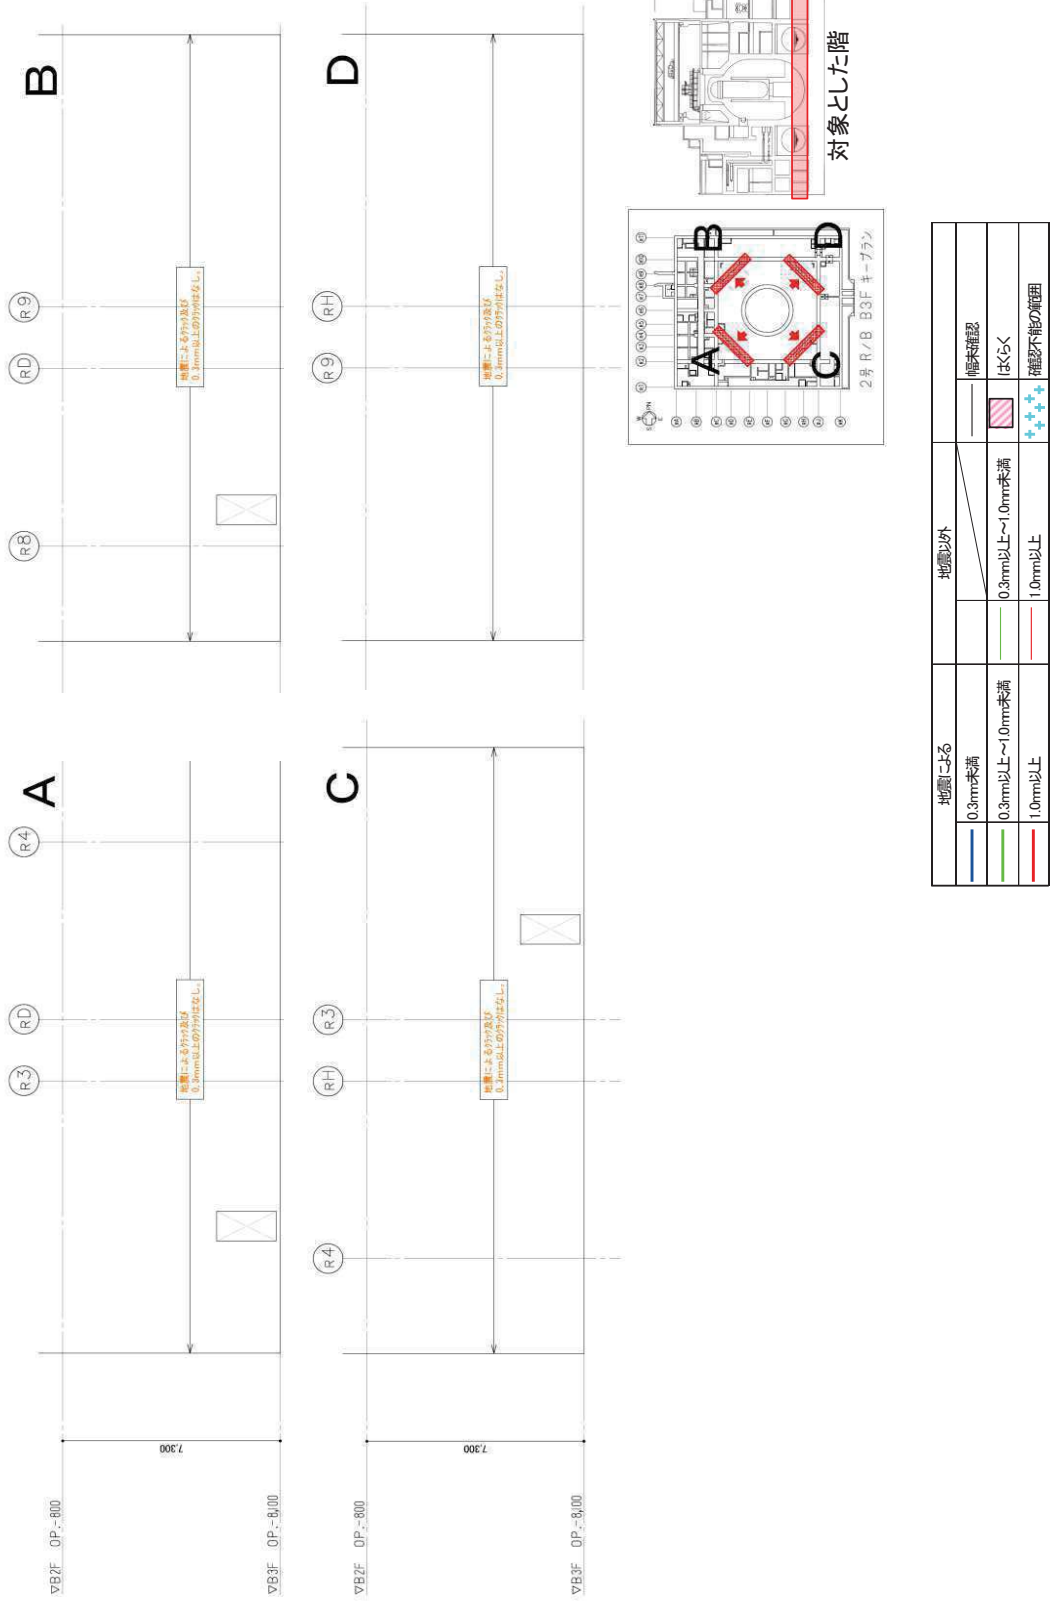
原子炉建屋のひび割れ分布 耐震壁 (9) 地下3階 火打ち壁
